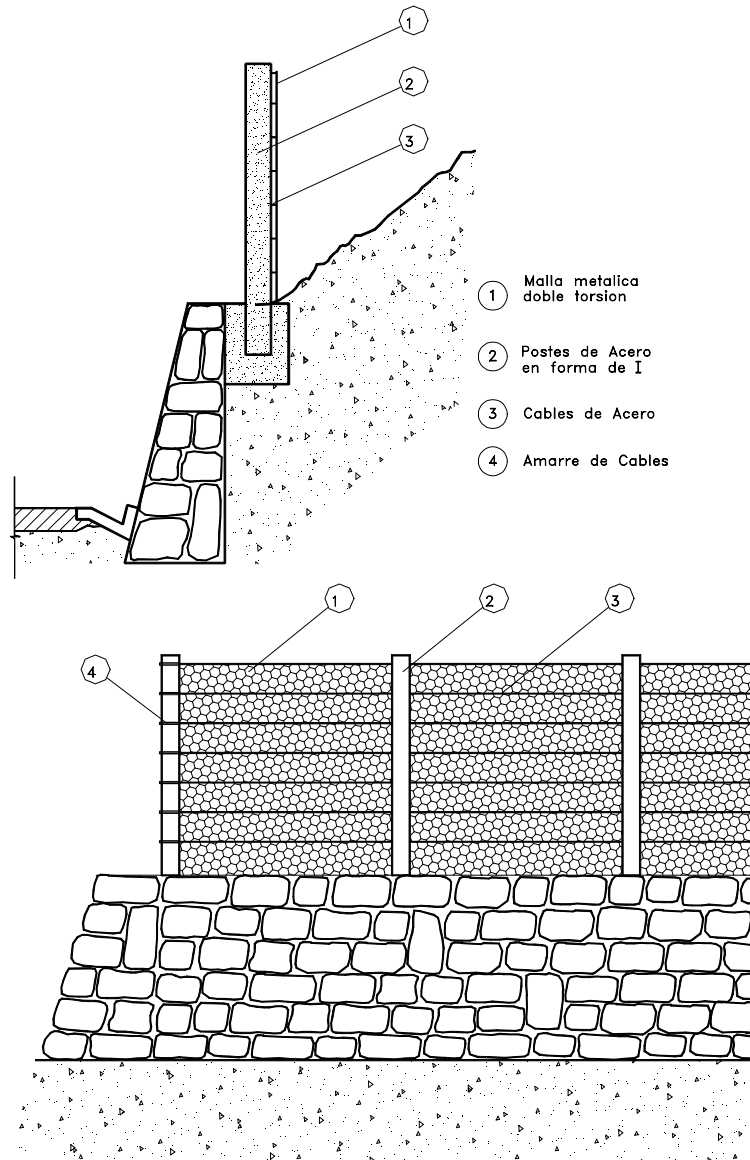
Sistema de barrera metálica con cables de acero, para control de caídas de bloques de roca (Gaviones Maccaferri).
